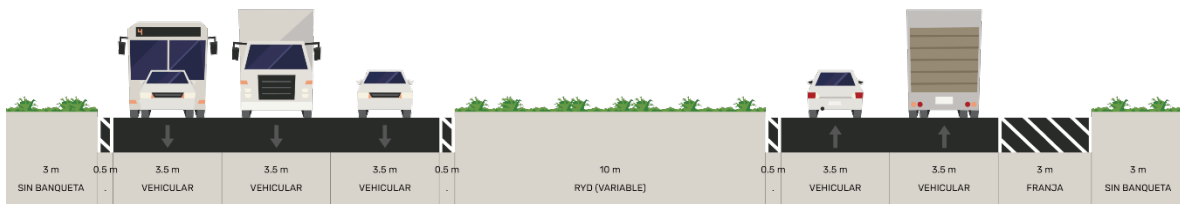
Estructura Vial y Conectividad. Fuente: Elaboración propia.
